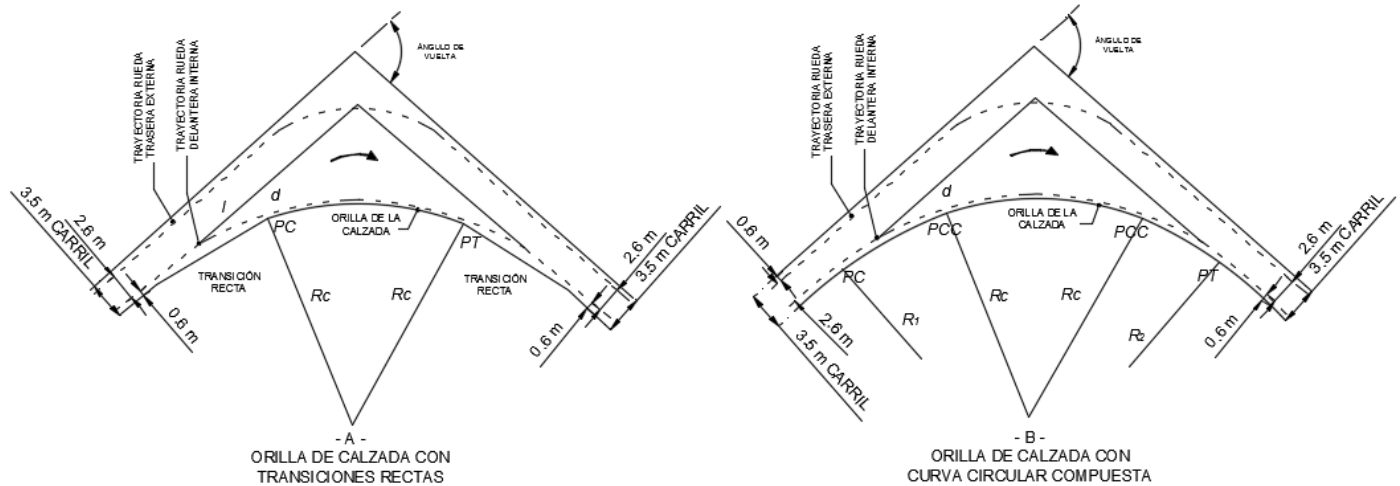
Proyecto mínimo de la orilla de calzada
